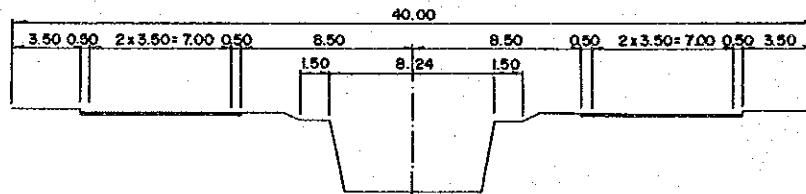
PROPUESTA DE LA SECCION TRANSVERSAL EXISTENTE
